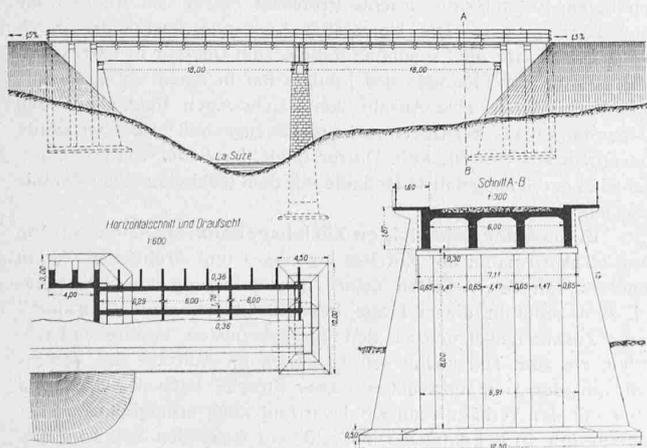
Ansicht, Draufsicht und Schnitte. — 1: 600 und 1: 300.
